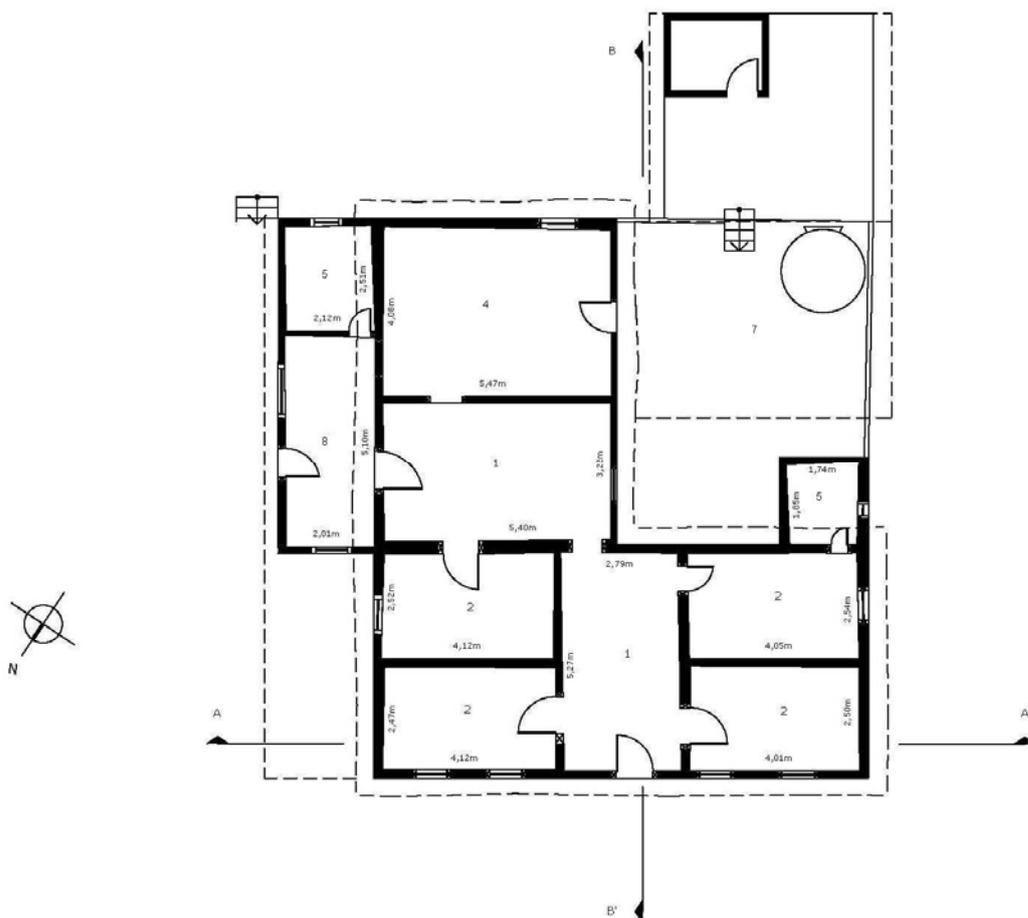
Planta baixa da casa da Fazenda Monjolo II. Área do Núcleo Básico de 66,08 m²; Área total de 133,07 m² (Acervo PROAU/FAU/UnB).
